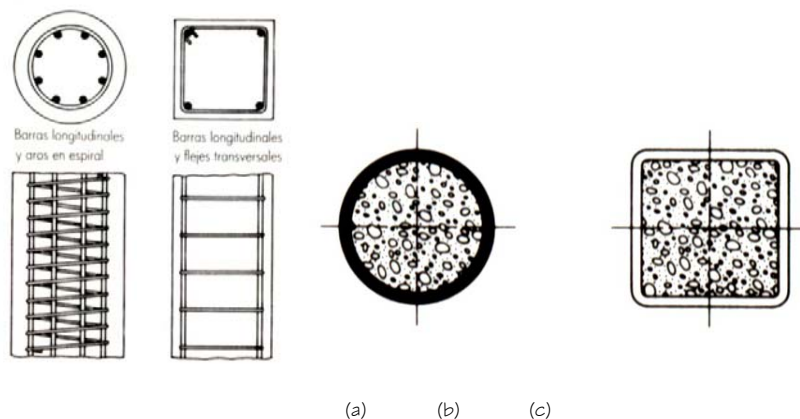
Tipos de columnas de concreto armado. (Nilson y Winter, 1994, p.20; McCormac, 1996, p.479).
